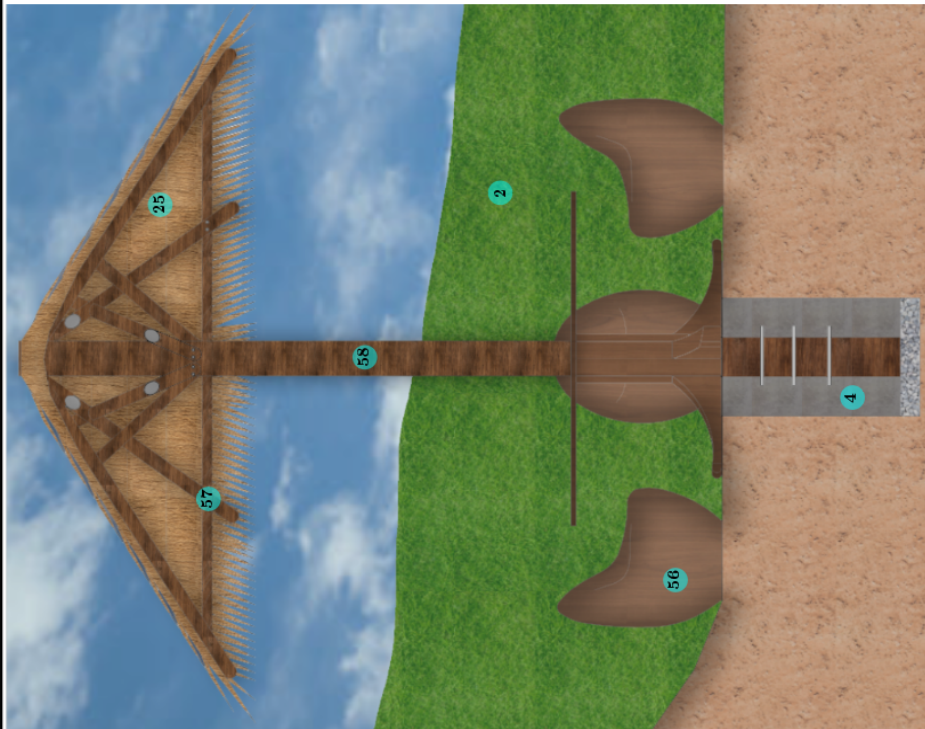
Detalles Constructivos. Fuente y Elaboración: Propia. (Ver Anexo 36)
